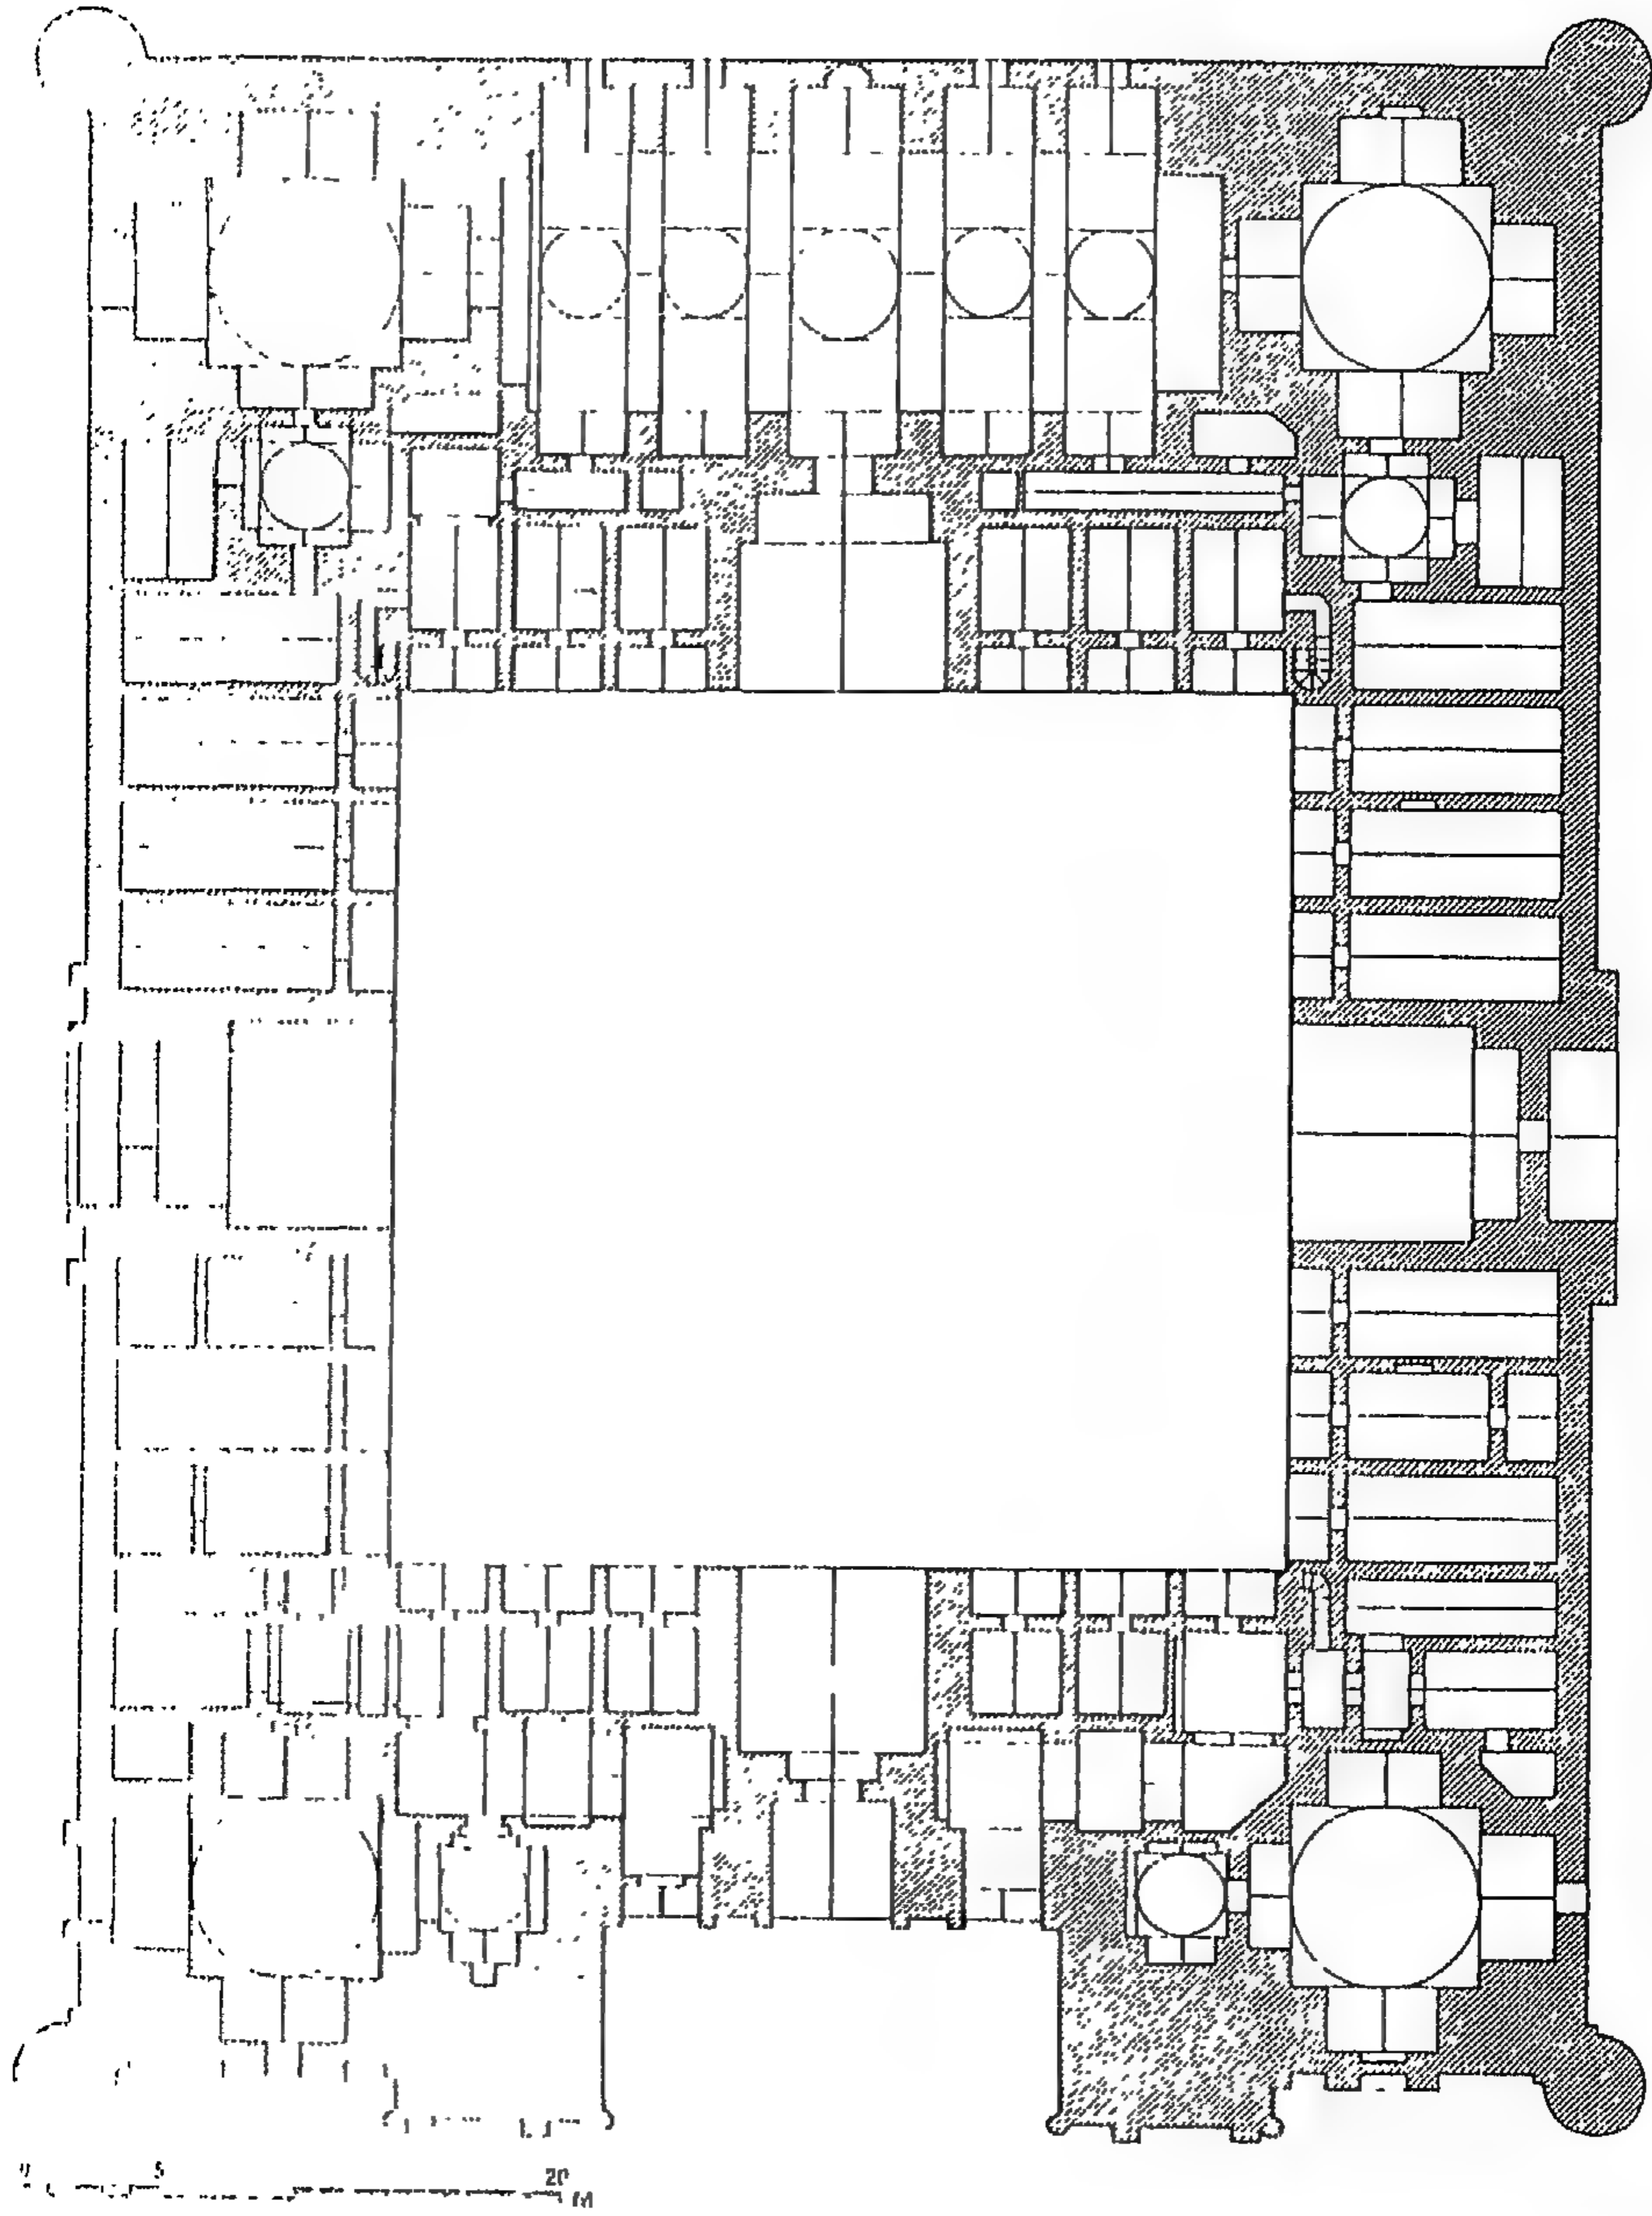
مسقط أفقي لمدرسة اسحاق باشا في اينه كول (عن : Goodwin) .
